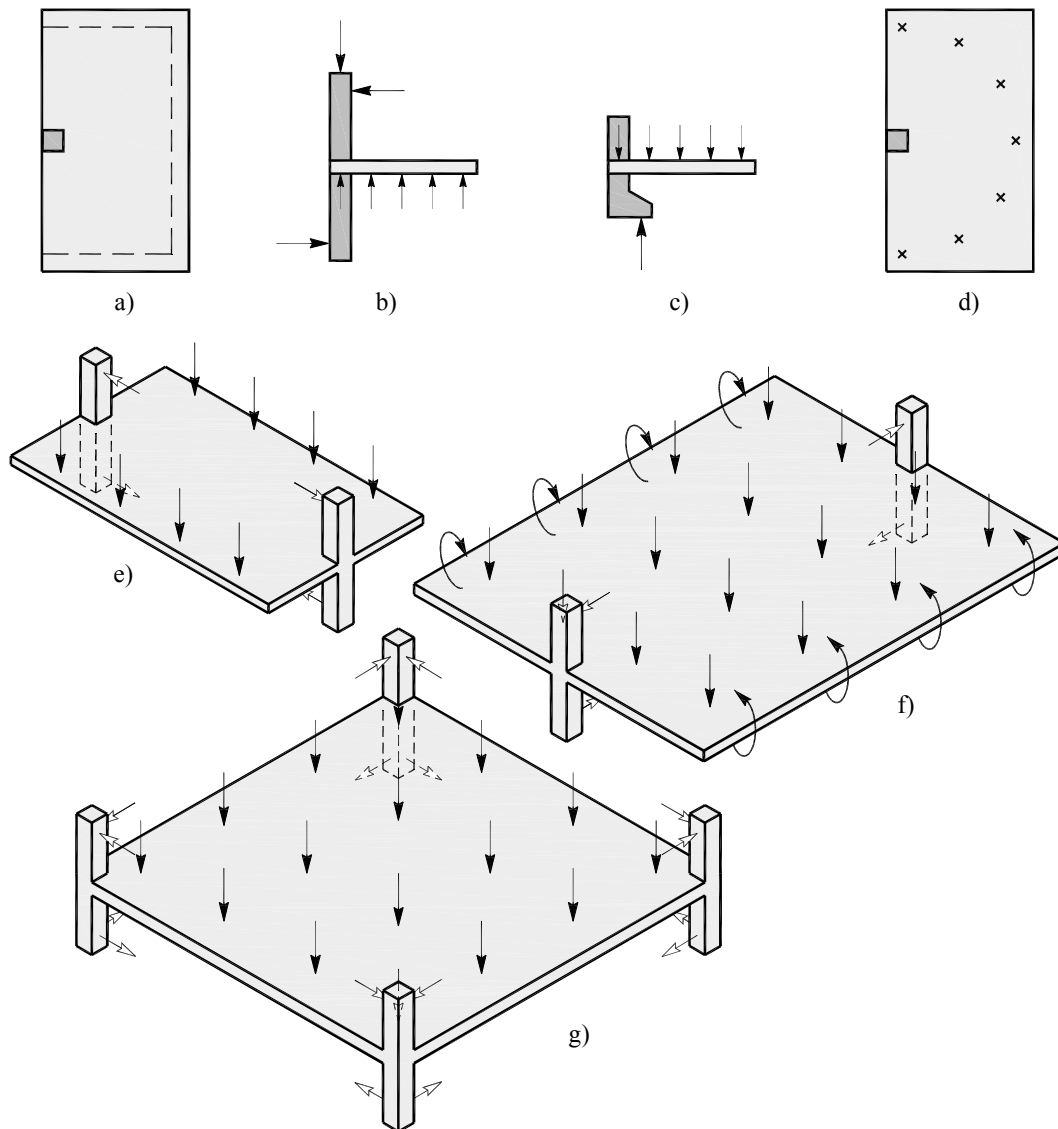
Modelos complexos para o estudo de ligações laje-pilar de borda e canto
